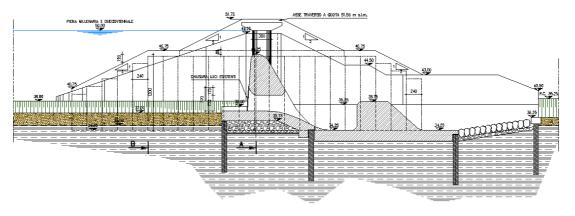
Adeguamento manufatto di regolazione in linea - Sezione tratti laterali
